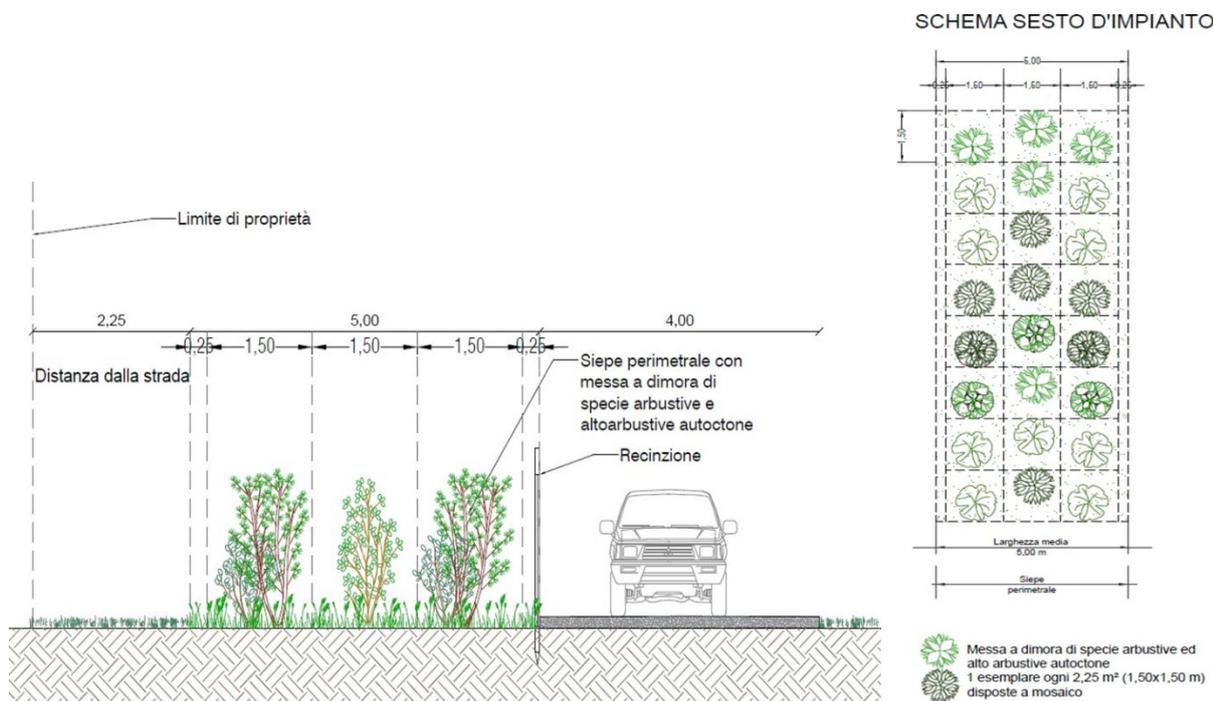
Sezione tipo e sesto d'impianto della siepe perimetrale
